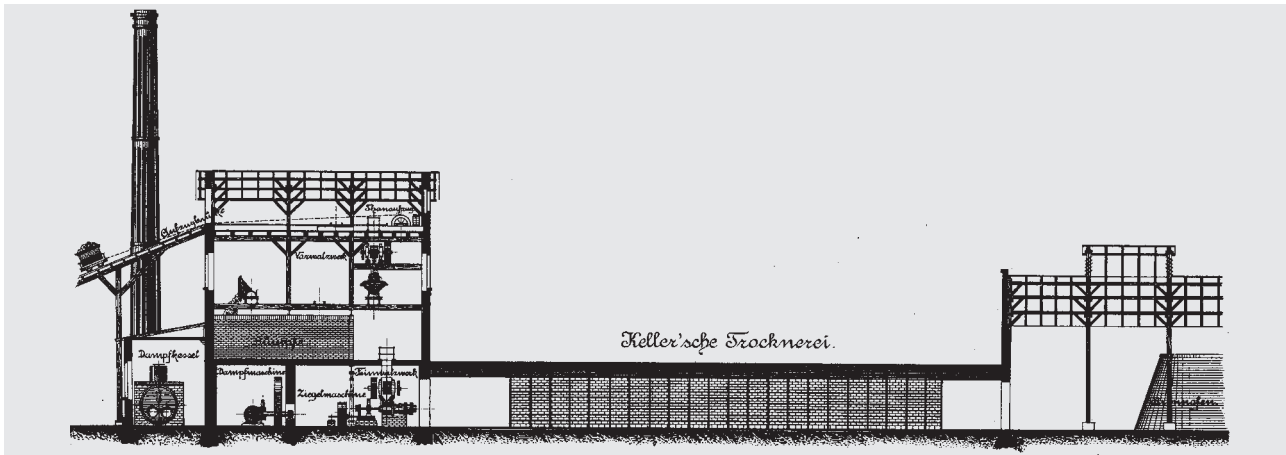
Dampfziegelei um 1910, ähnlich Bild 4.28., jedoch mit ebenerdigem Kammertrockner
